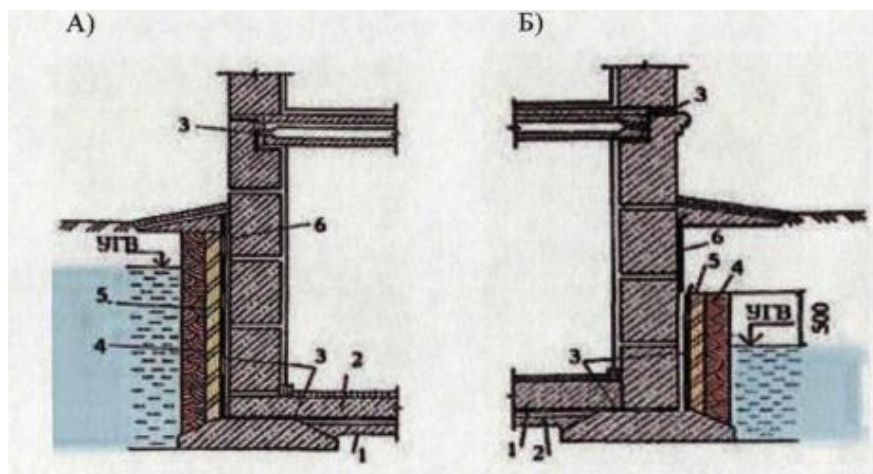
Гідроізоляція фундаменту малоповерхової будівлі.
